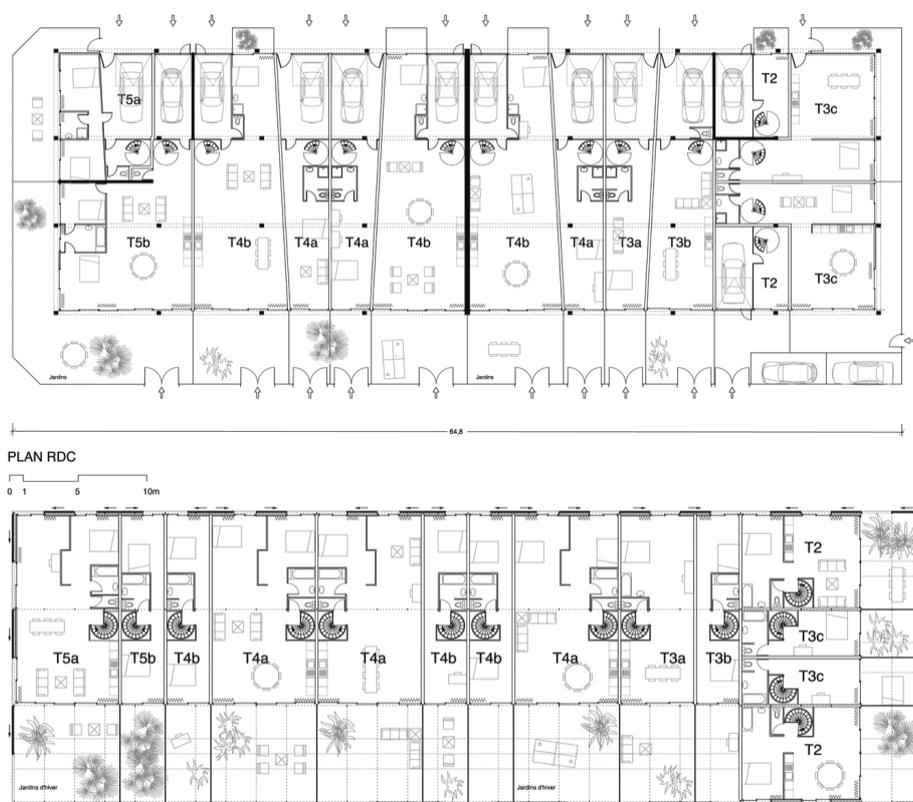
Planta baixa térreo e primeiro pavimento Habitações de Mulhouse. Lacaton e Vassal, 2001. Fonte: Lacaton e Vassal.
